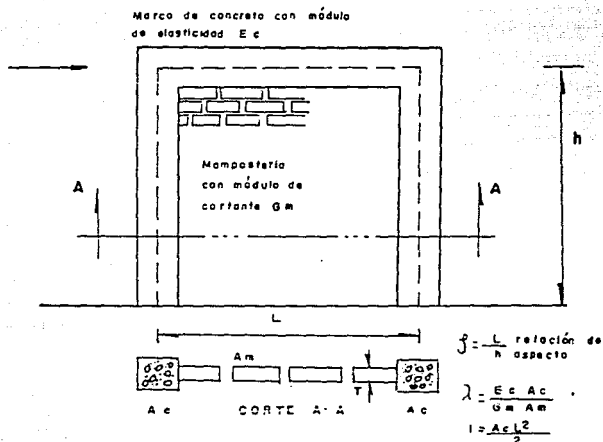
Definiciones empleadas para determinar la rigidez lateral de muros de mampostería confinados por marcos de concreto
